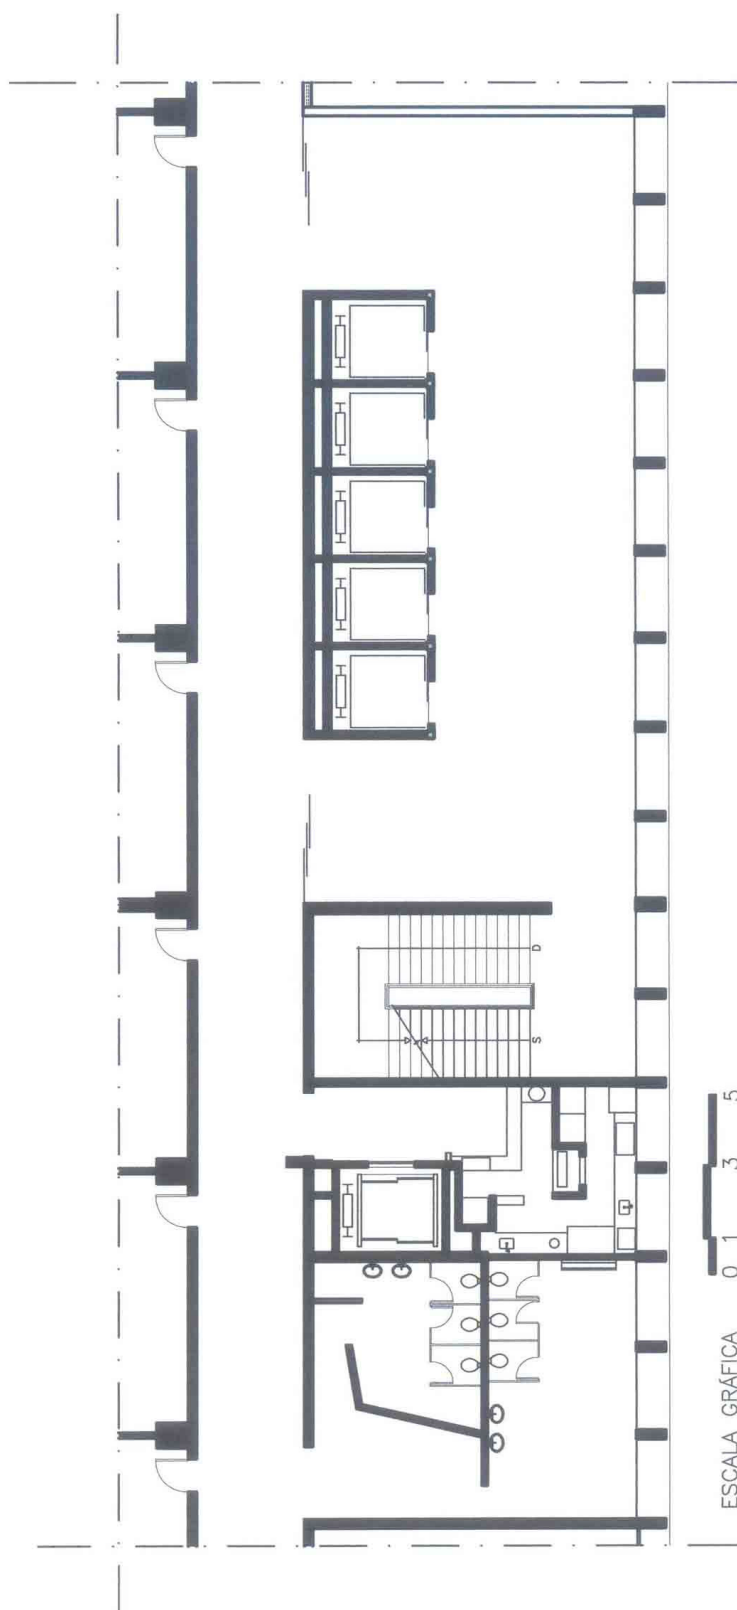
Projeto nº 6 – Planta baixa do 5º pavimento: trecho da intervenção (Imagem disponibilizada pela equipe nº 6)
